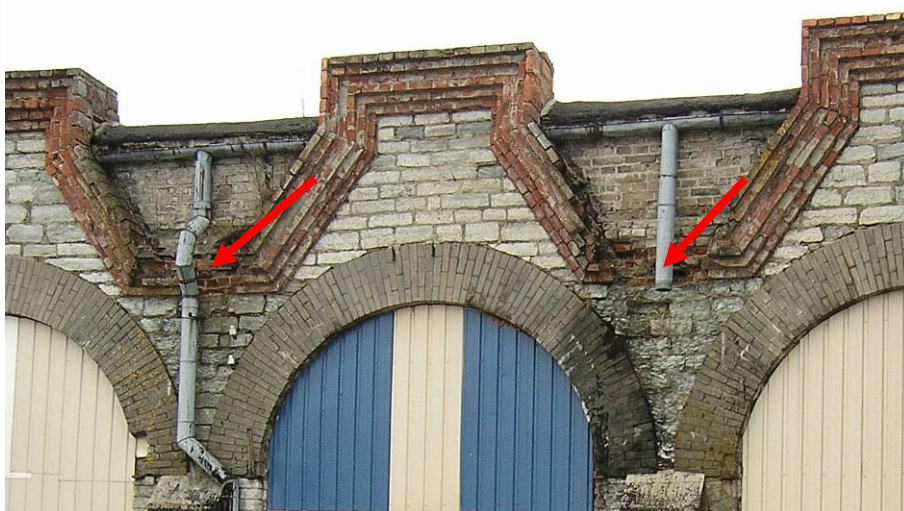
Puudulik sadeveesüsteem ja lagunemisilmingud
